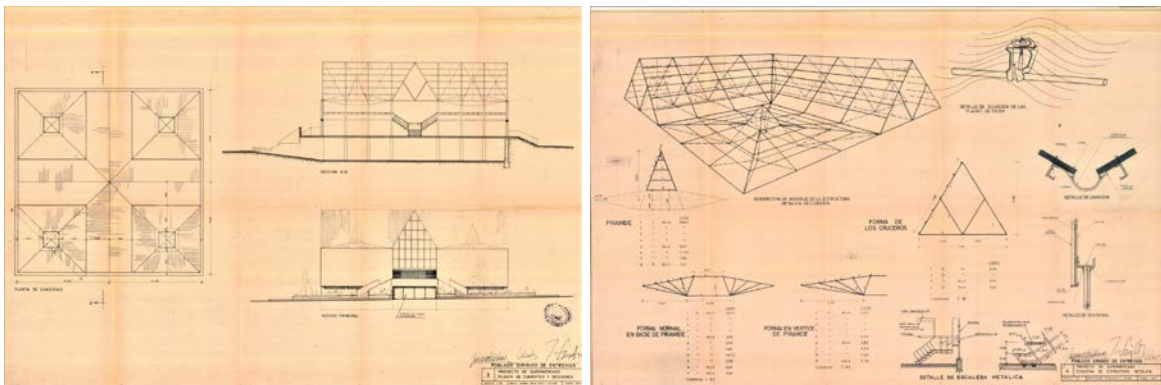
(izda.). Poblado Dirigido de Entrevías, 2ª Fase, Proyecto de Supermercado, Planta de Cubiertas, Sección y Alzado, enero 1961
